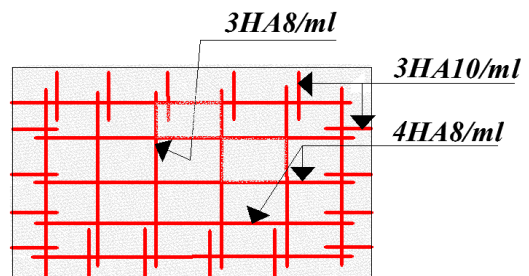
Schéma de ferrailage de la dalle au-dessous de l'ascenseur
